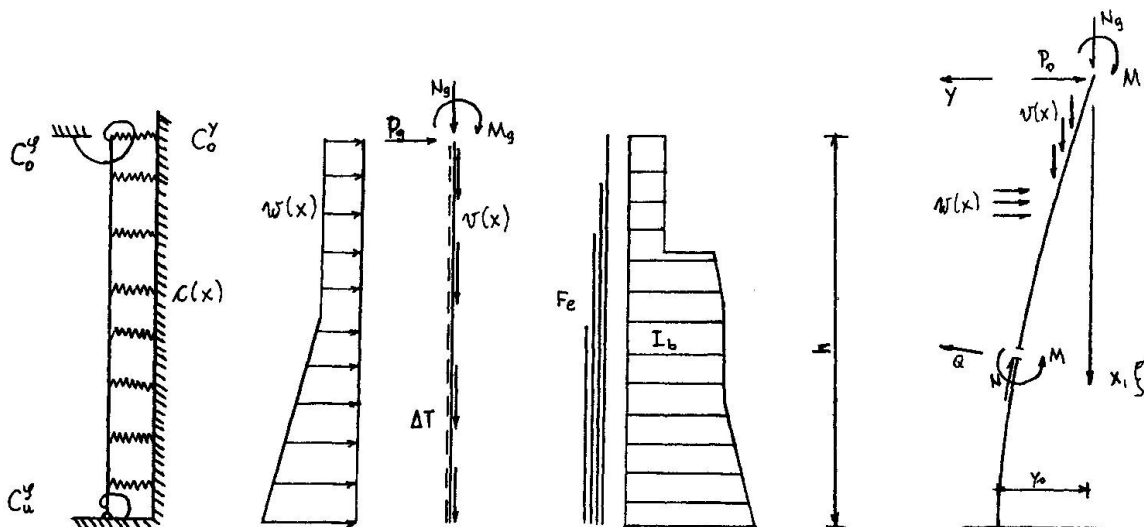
Art der Lagerung, Art der Belastung und Verteilung des Bewehrungsstahles und der Betonträgheitsmomente des Stabmodells
